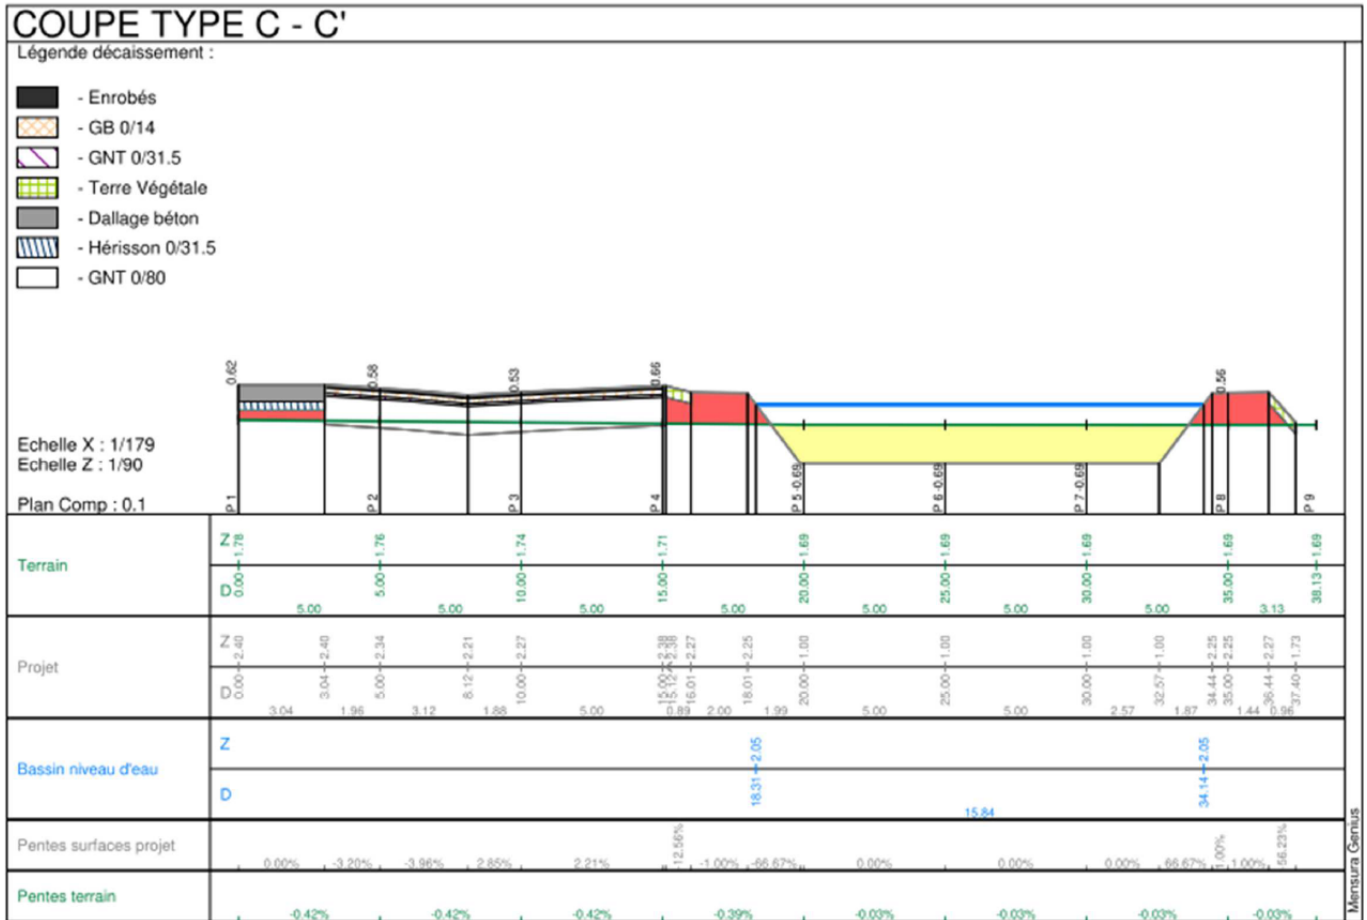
Plan de coupe des ouvrages de gestion des eaux pluviales
